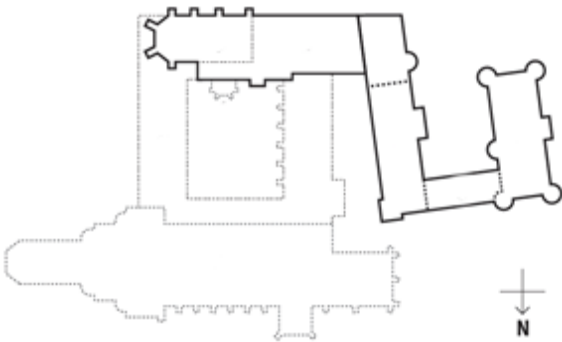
Grundriss Schlosskomplex um 1650, Darstellung Sigmar Löffler
